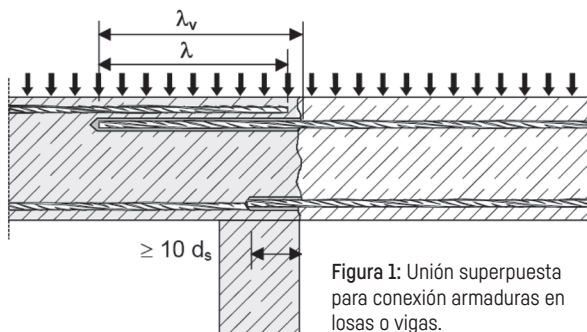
Unión superpuesta para conexión armaduras en losas o vigas.
